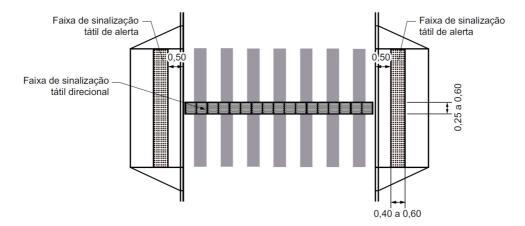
Travessias junto a rebaixamentos de calçada. Fonte: NBR 16537/2016.
